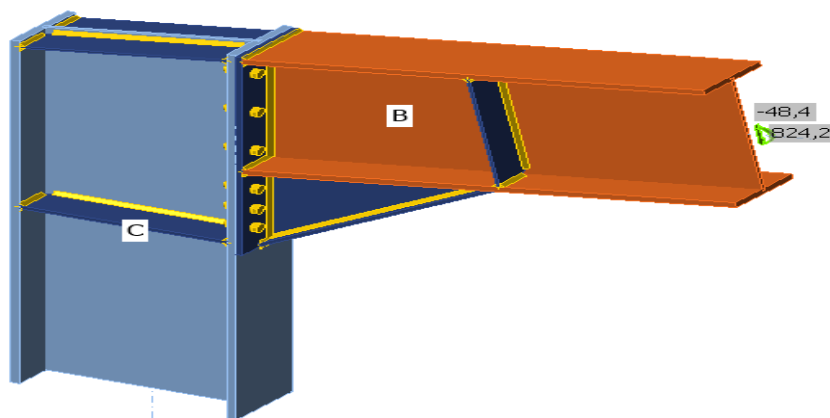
Vue d'assemblage poteau HEA700–Poutre HEA600
